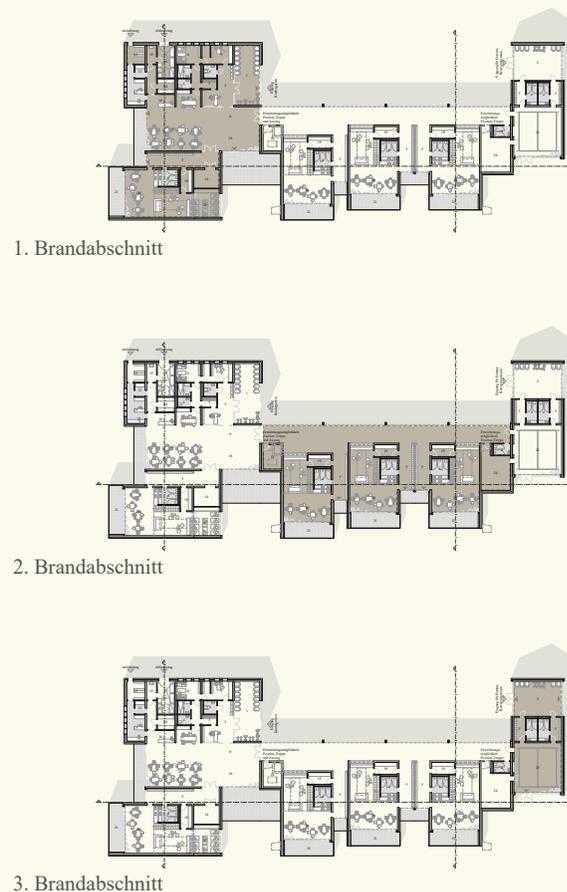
, Grundrisse mit Darstellung der einzelnen Brandabschnitte
